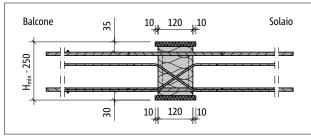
Schöck Isokorb® tipo DXT50-VV6: pianta
